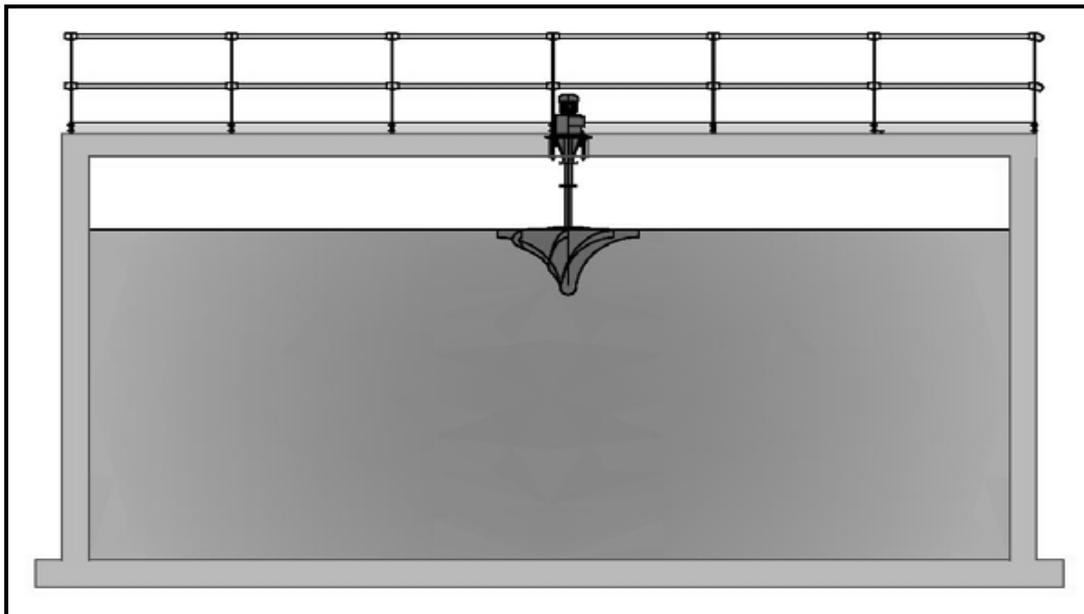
Coupe sur bassin d'aération aéré mécaniquement.
